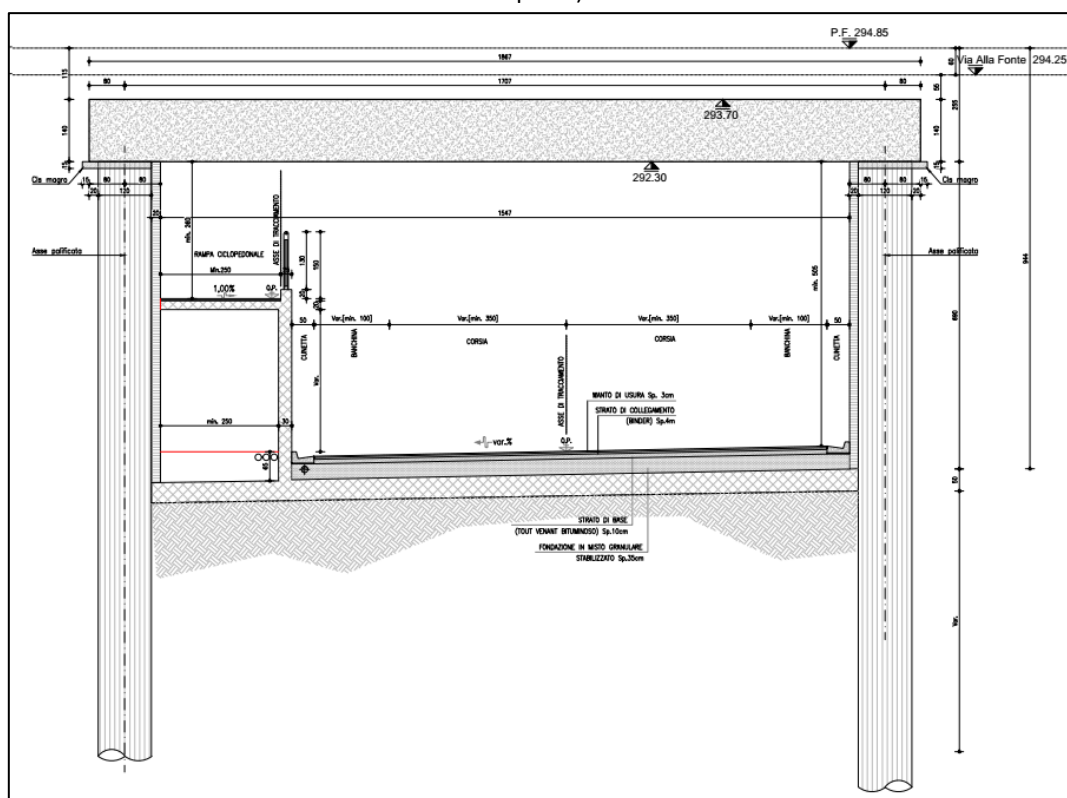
Sezione tipo asse principale con pista ciclopedonale e palificata con soletta
